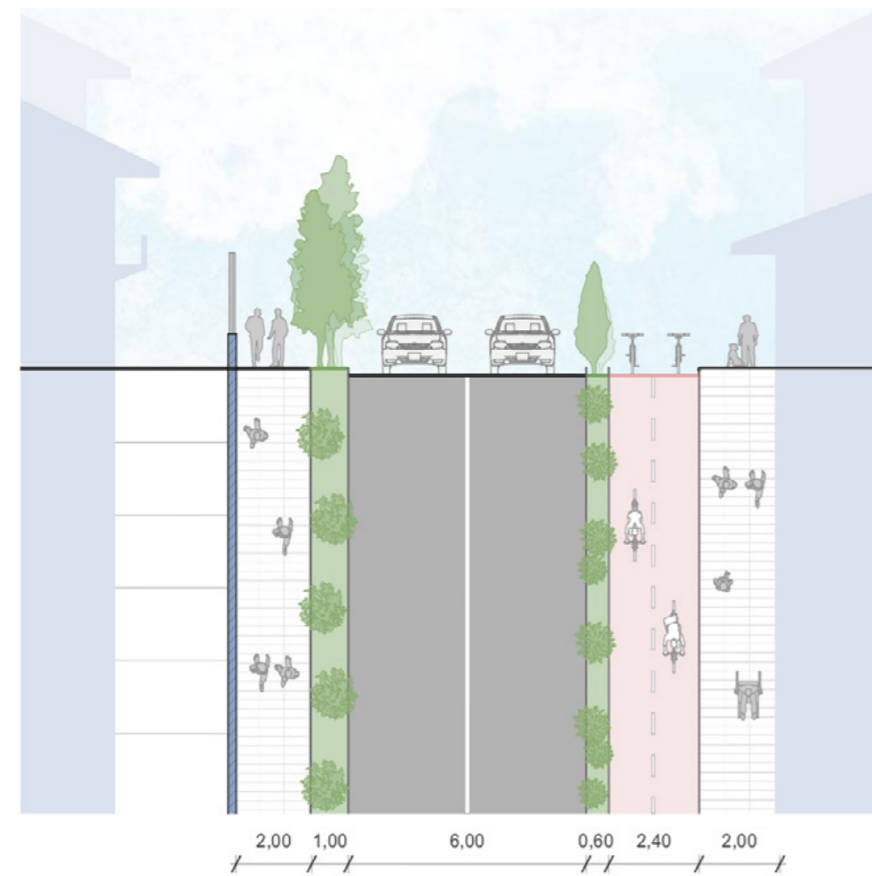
Sección constructiva propuesta calle Barrial Blanco. Fuente propia
